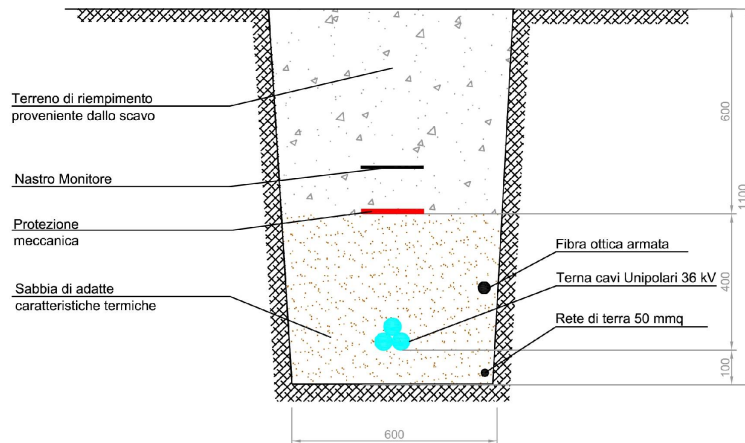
Sezione tipo di scavo su terreno agricolo
